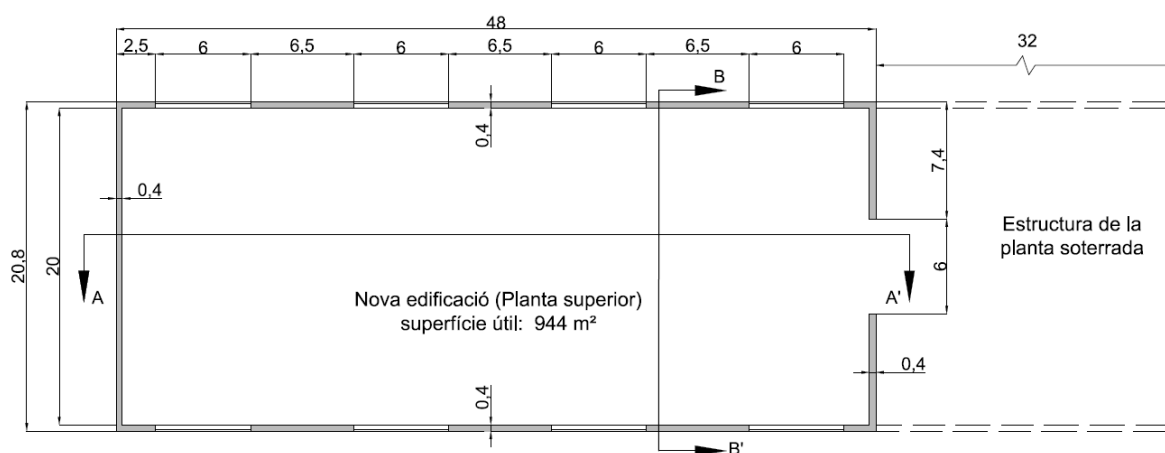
Vista simplificada del Plànol 20. Vistes en planta i alçat de la planta superior de la nova edificació.
